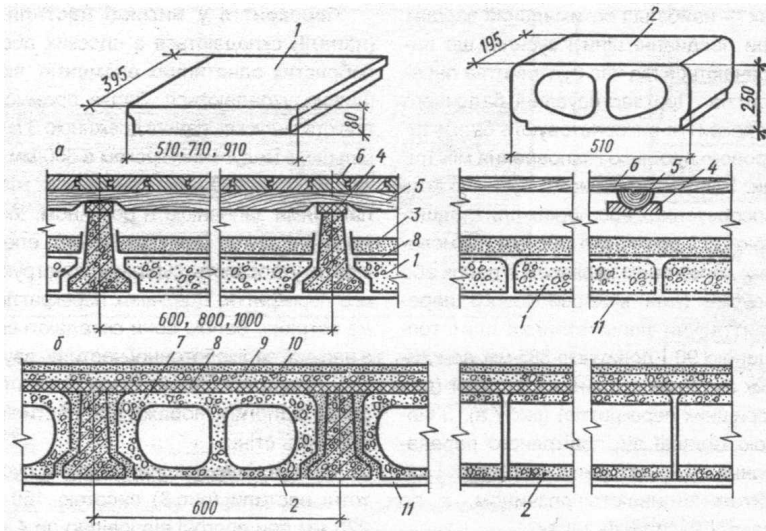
Міжповерхові перекриття по збірних залізобетонних балках: а - з накатом із плит; б - з заповнення вкладишами; 1 - гіпсобетонні плити; 2 - ленкобетонні вкладиші; 3 - шлак; 4 - звукоізоляційна прокладка; 5 - лага; 6 - дерев'яна підлога; 7 - оргаліт; 8 - толь; 9 - легкий бетон; 10 - чиста підлога; 11- затирка
